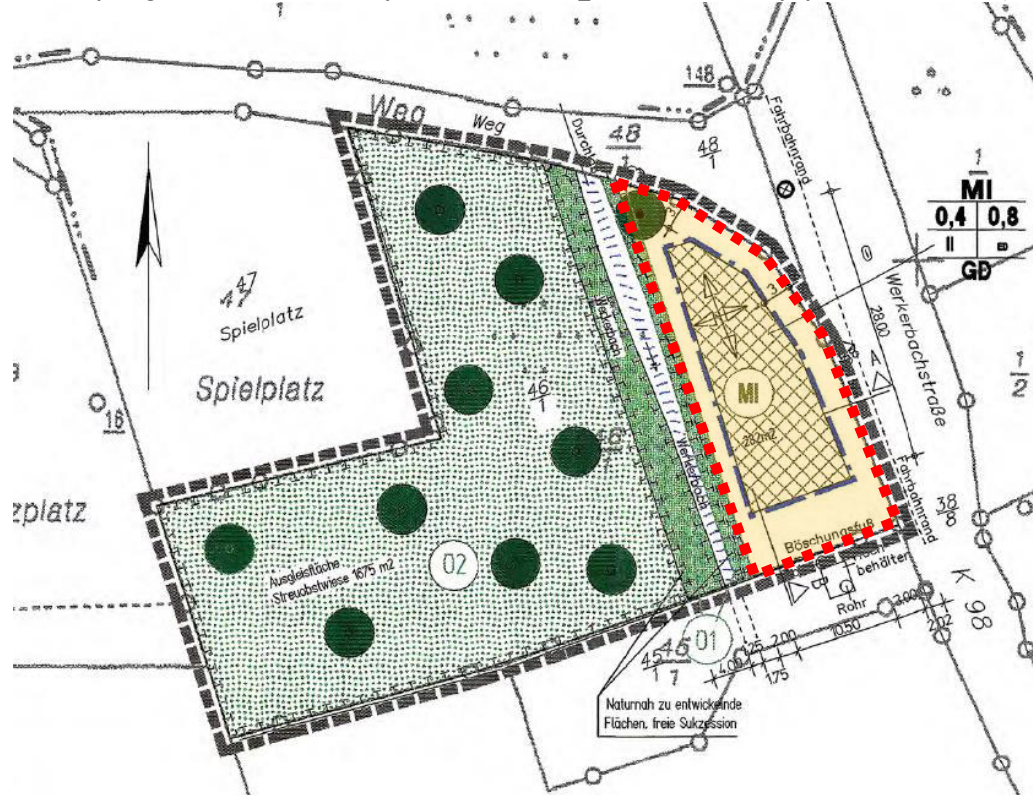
Abgrenzung des Änderungsbereichs der vorliegenden Planänderung (rot markiert) (ohne Maßstab)
